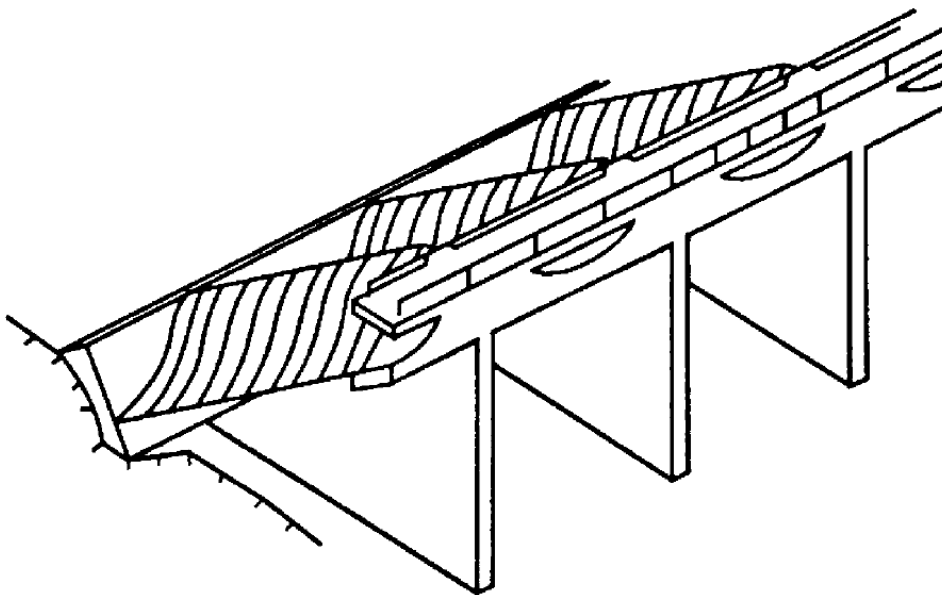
Barragens de concreto em contraforte (Fonte: MASSAD, 2010)
